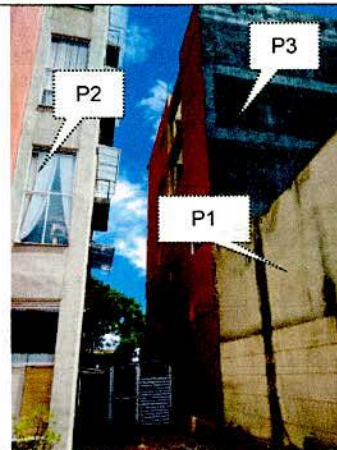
Vista de la vivienda ubicada en el predio P1, se observan deformaciones en fachada.
